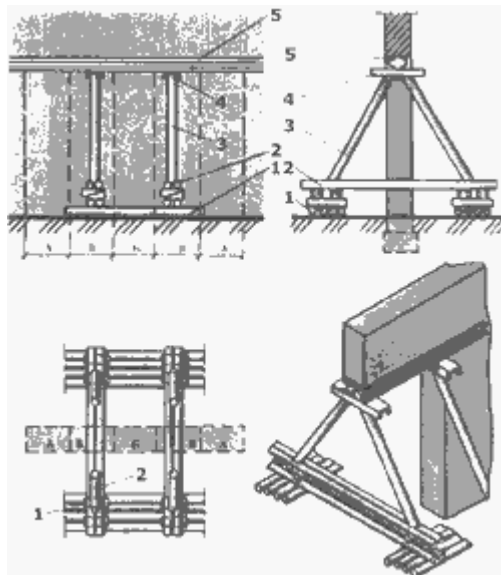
Конструкции креплений при перекладке больших участков стены: 1 - лежни; 2 - затяжка; 3 - стойки; 4 - подкладка под стойки (швеллер или деревянный брус); 5 - металлические балки; А, Б, В - зоны различных нагрузок при трансформации стены.
